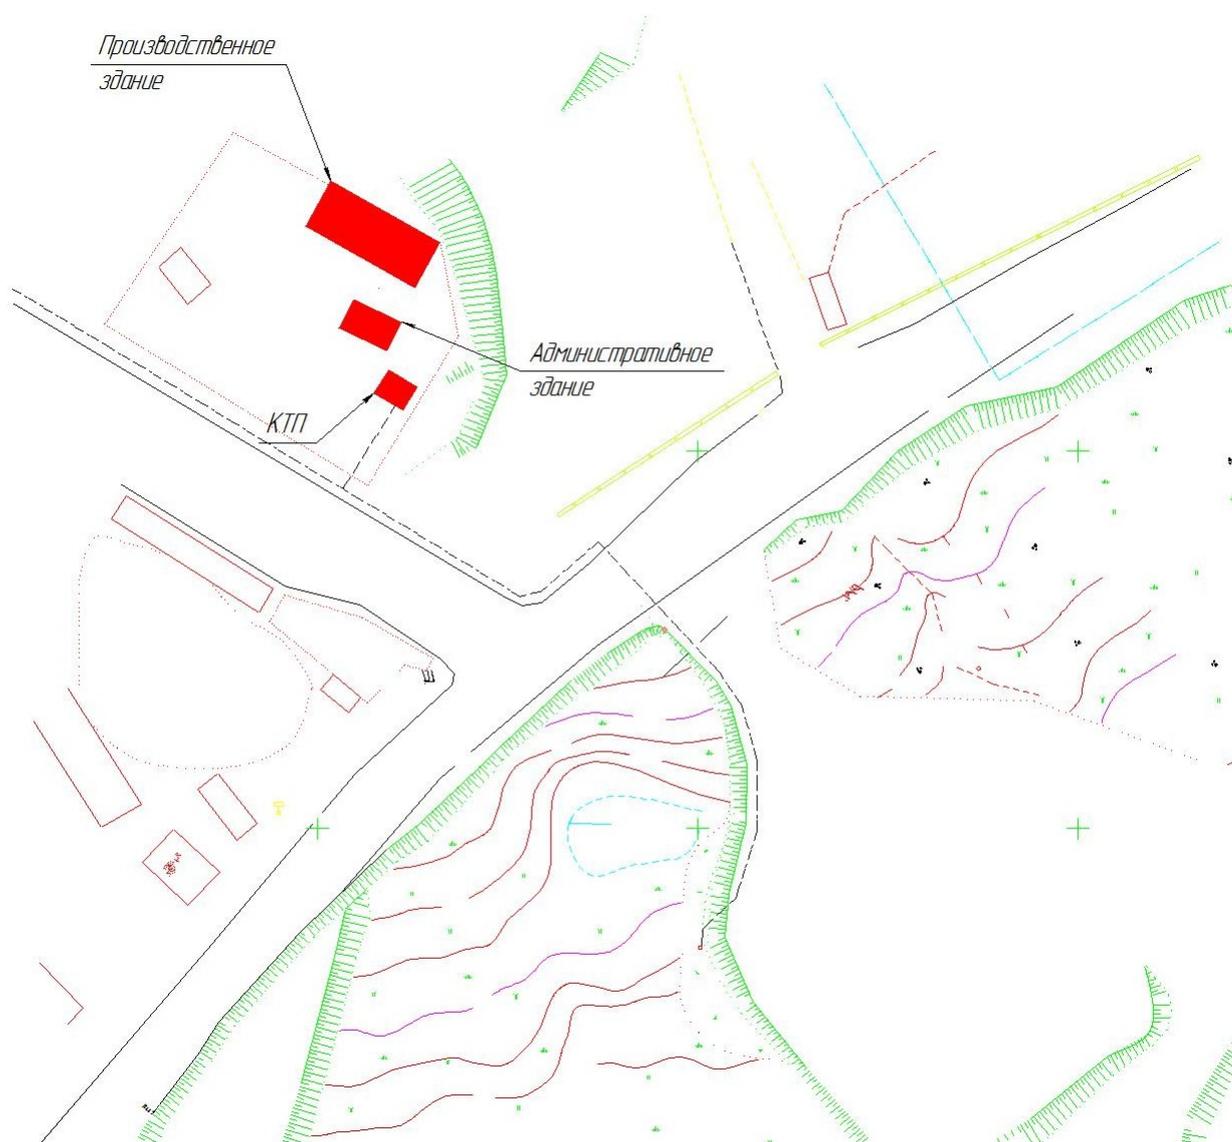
Генеральный план размещения зданий ООО «Зенит-КМ» и электрооборудования
